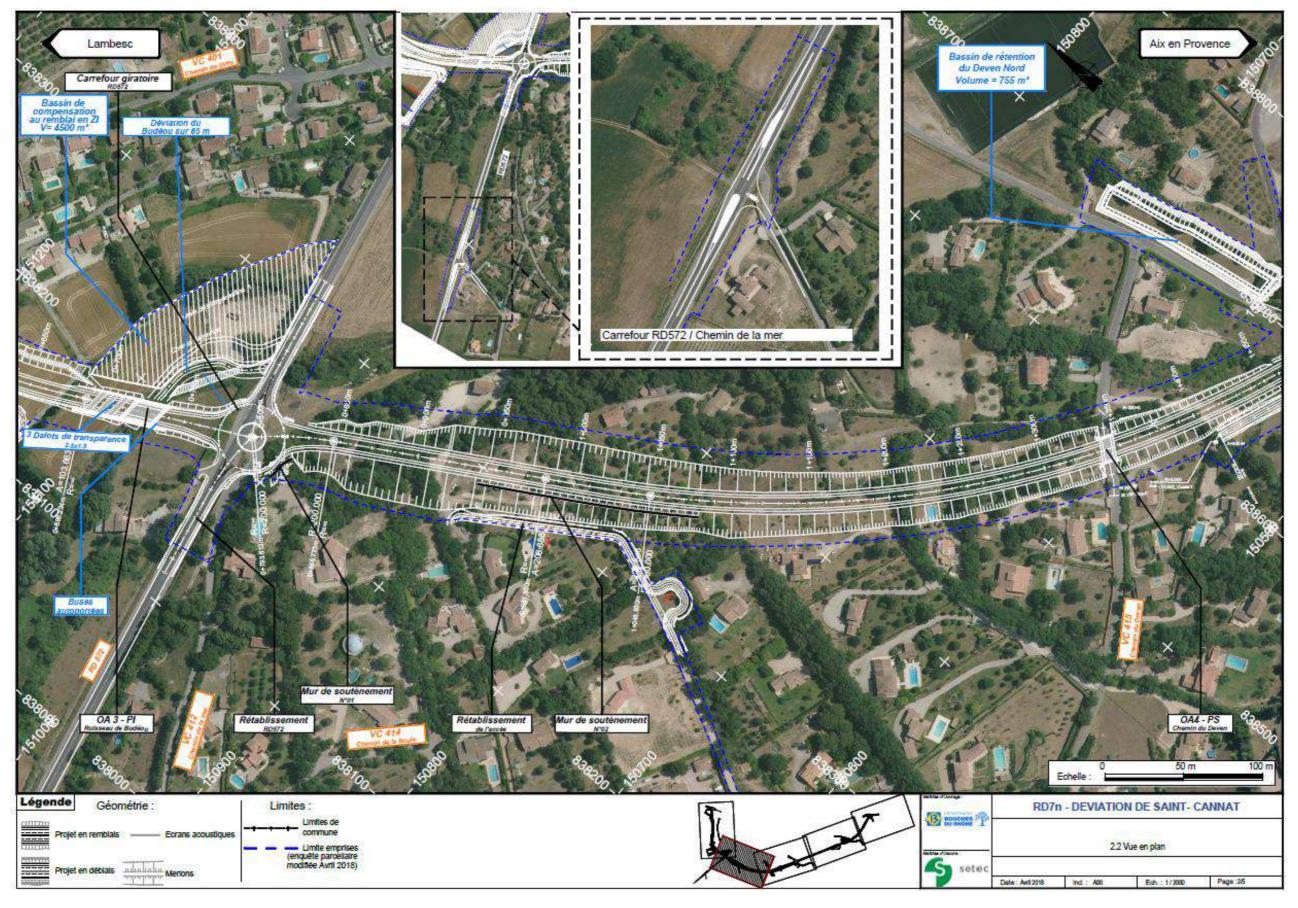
Vue en plan du tracé (planche 2/5) ; source : SETEC
